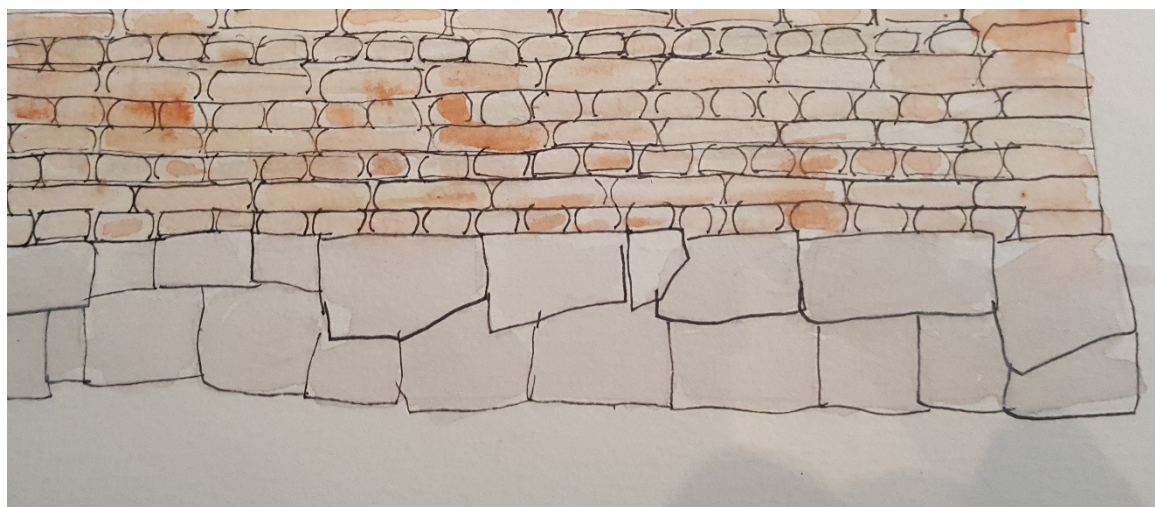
Croqui do encaixe da base em pedras do casarão com os tijolos da parede.
